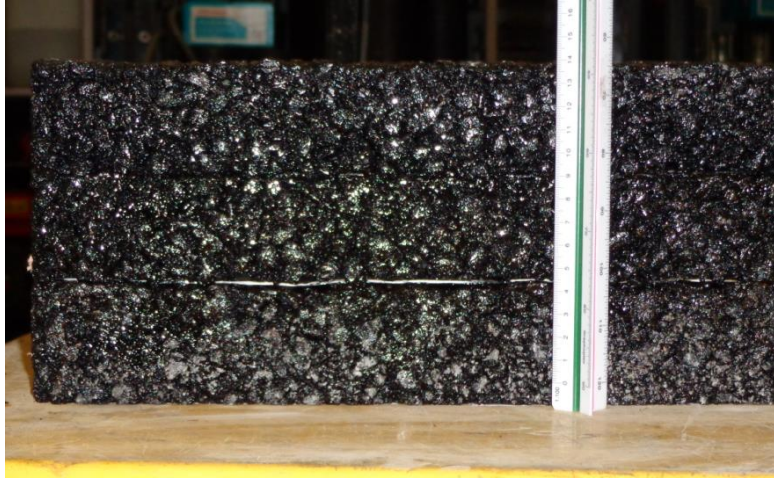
Section d'une plaque renforcée en structure tri-couches, H = 15 cm (5 + 5+ 5)
